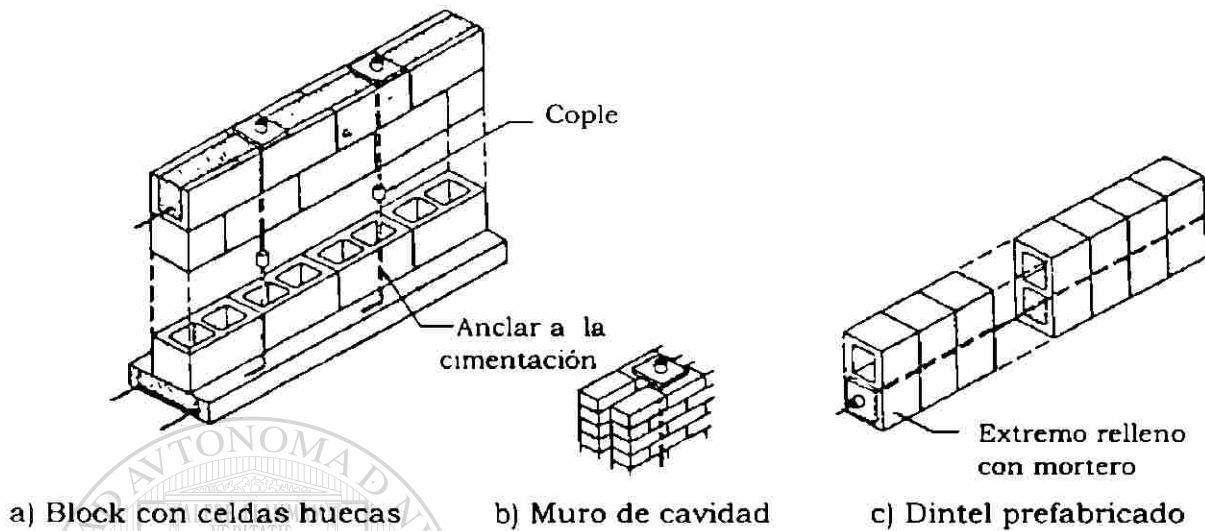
Ejemplos de mampostería pre-esforzada.
